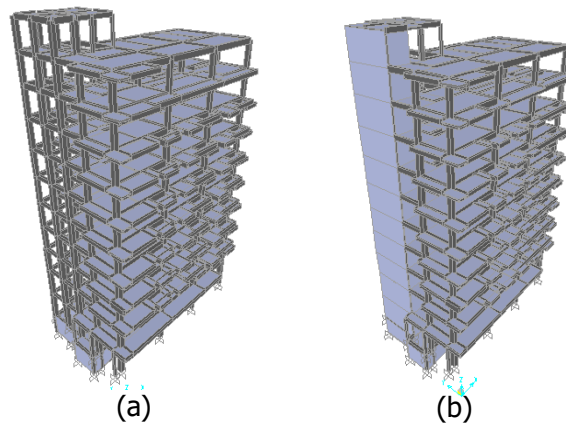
Konfigurasi kolom struktur tipe 1 tanpa *core wall
